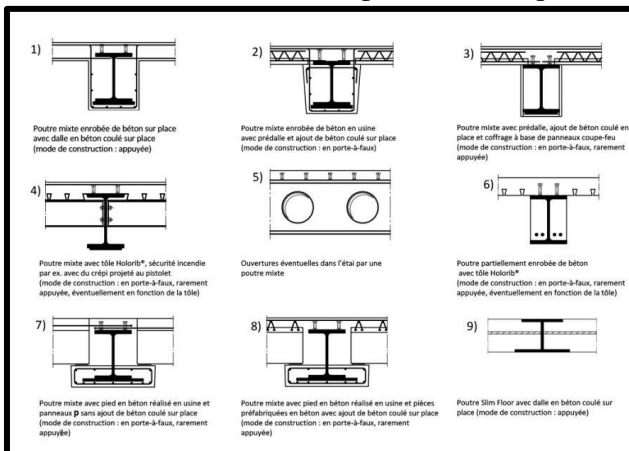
Poutre mixte. Figure Source : L'auteur
